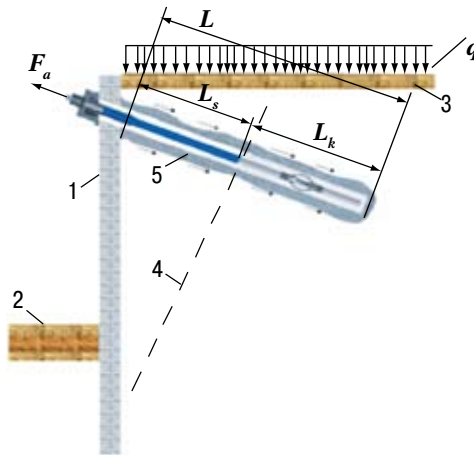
Схема ограждающей котлован стены, заанкеренной с помощью выдергиваемых свай: 1 — стена ограждения котлована; 2 — дно котлована; 3 — поверхность грунта за стеной; 4 — предполагаемая поверхность сдвига грунта; 5 — выдергиваемая анкерная свая;  $q$  — пригрузка на поверхности грунта;  $F_a$  — общее усилие растяжения в анкерной тяге;  $L$  — длина анкерной сваи;  $L_s$  — длина свободной части анкера или тяги сваи в пределах призмы обрушения грунта за ограждением;  $L_k$  — длина анкерного корня
